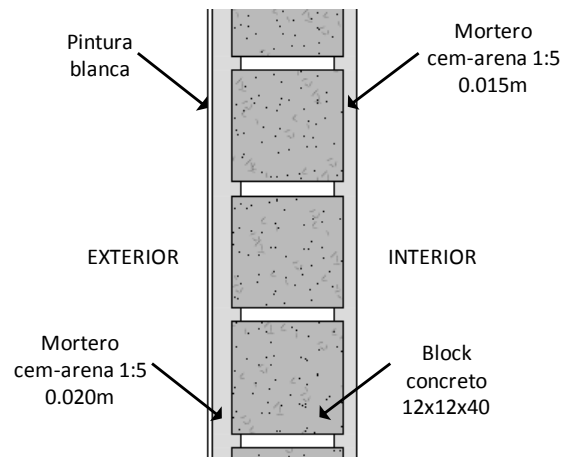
Corte esquemático de la superficie blanca en muro exterior
